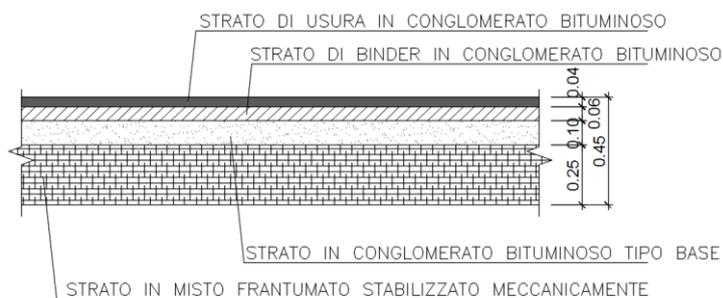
Pacchetto pavimentazione rami sud e nord della rotatoria
